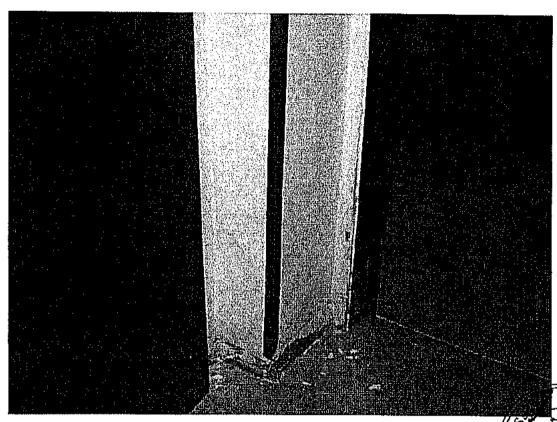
Colonna in corrispondenza del portone di ingresso all'immobil dell'esecuzione dei lavori
